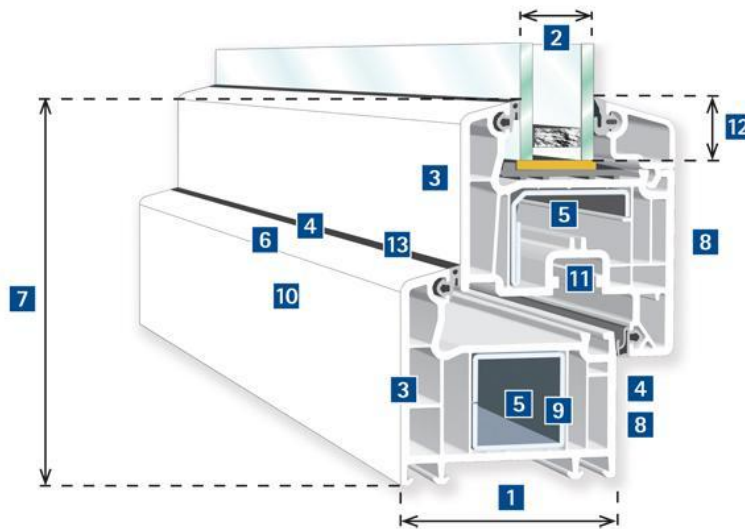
Perfil de la carpintería de PVC del inmueble.
